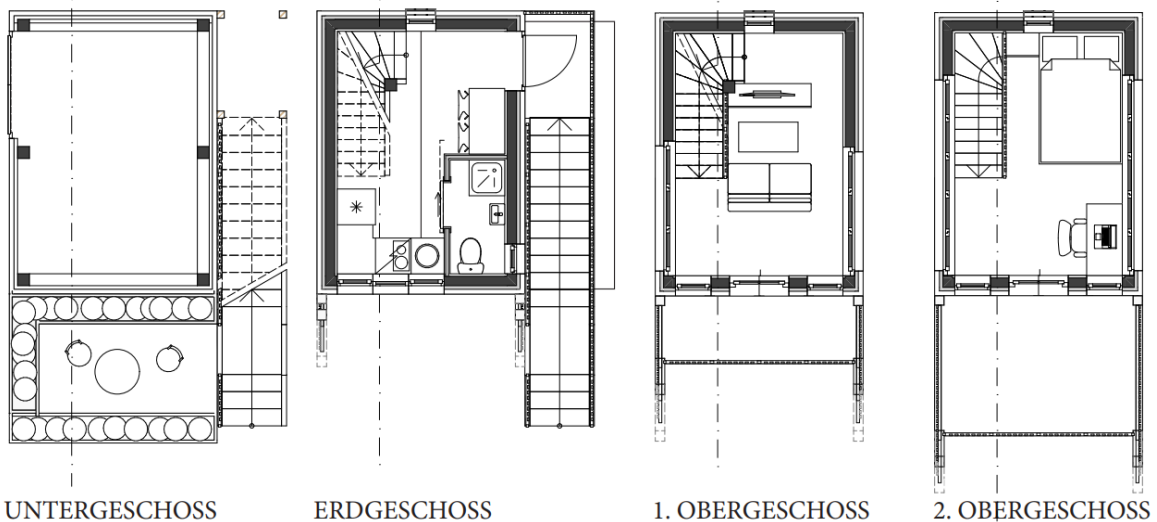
Grundrisse Entwurfspläne SS 2022
